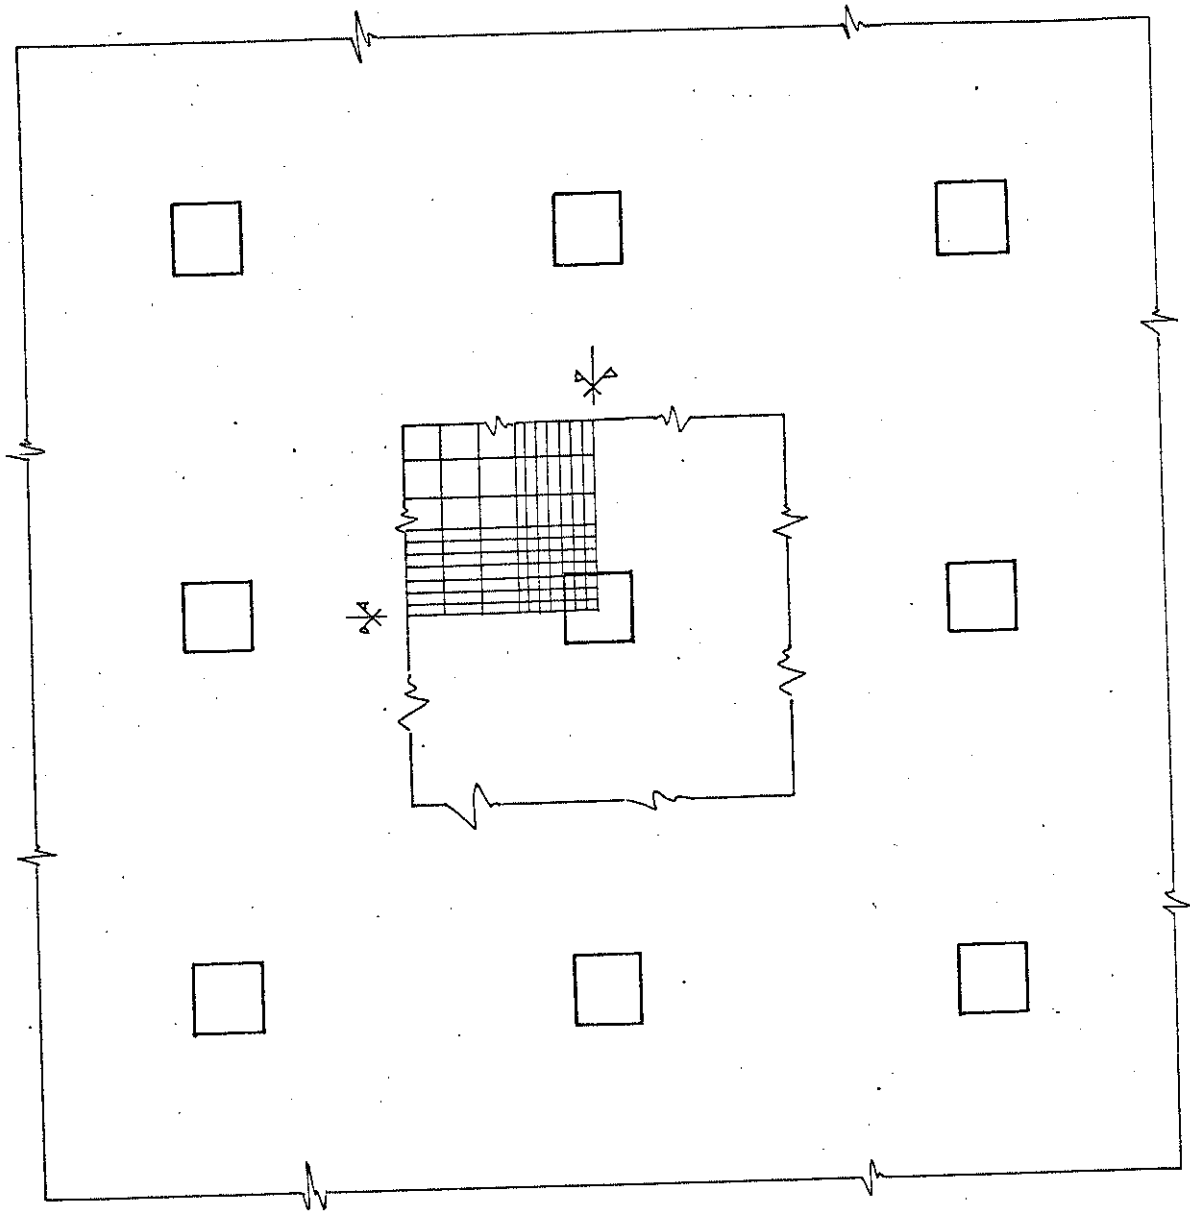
PLANTA ESQUEMÁTICA - LOCAÇÃO DOS PILARES
